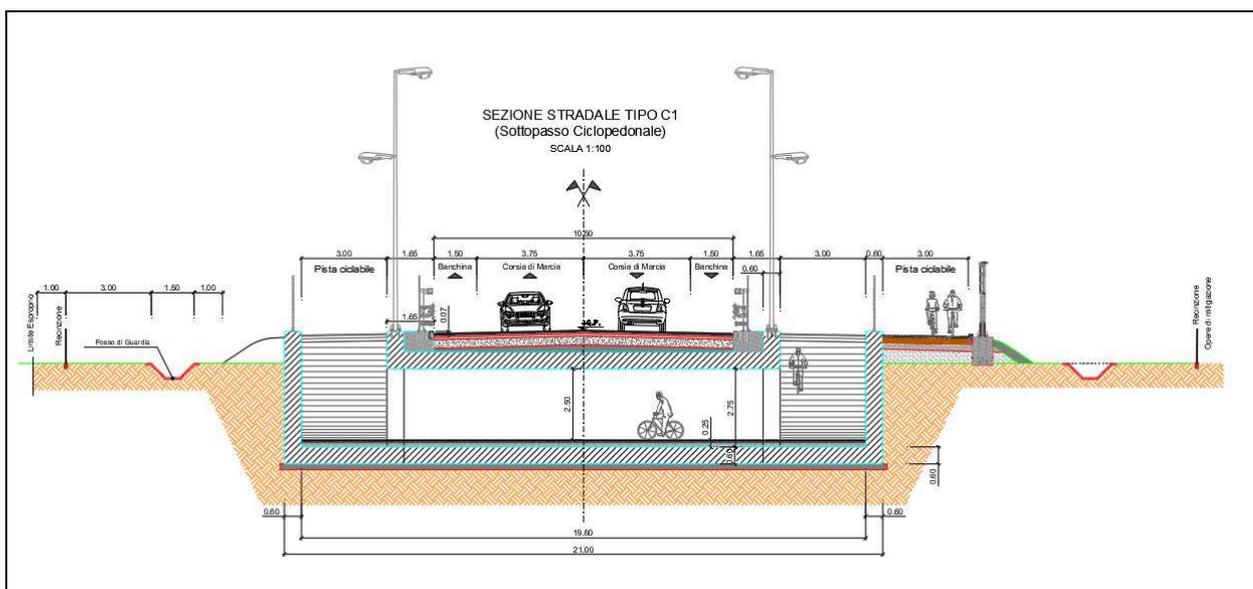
Sezione Stradale Sottopasso Ciclopedonale
